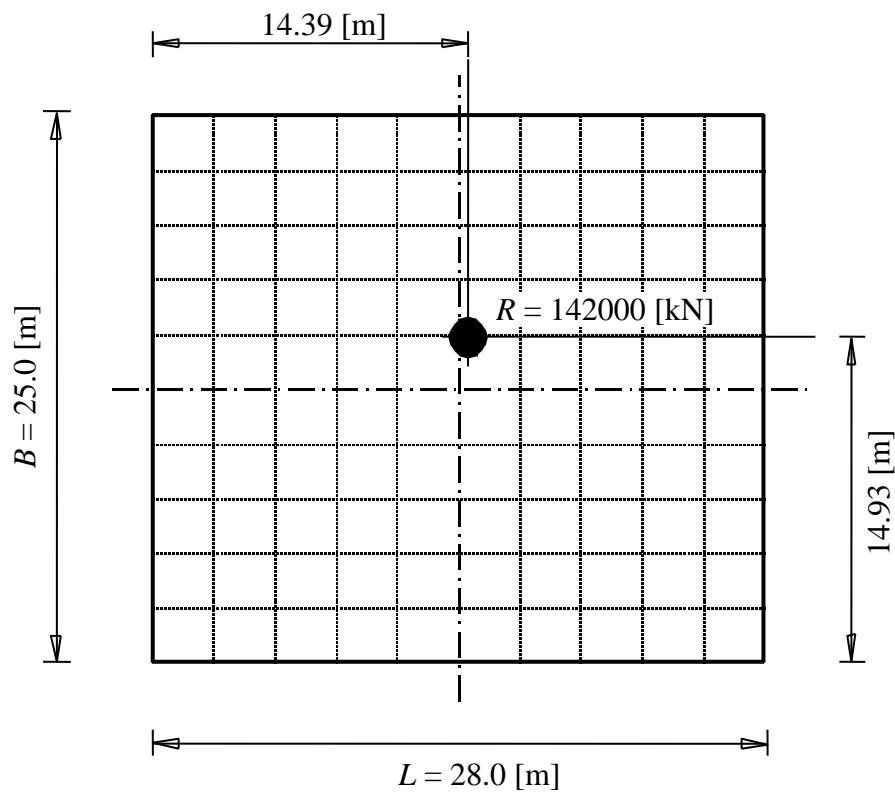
Grundriss der starren Platte, Last und FE-Netz
